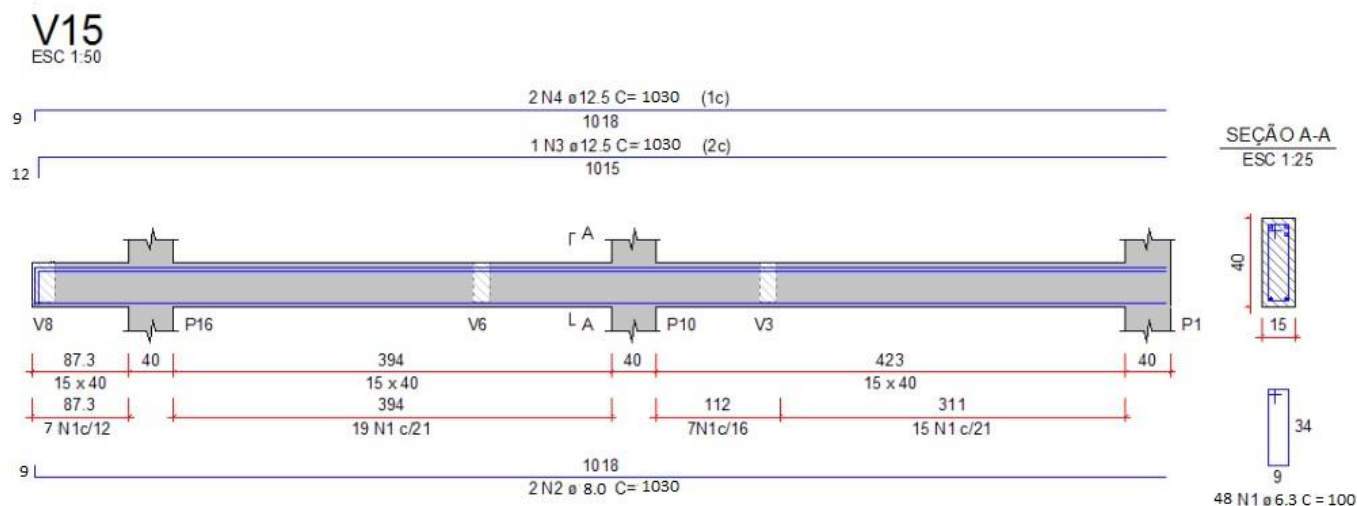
Detalhamento de viga de concreto armado (Fonte: Adaptado de AltoQi, 2026).
